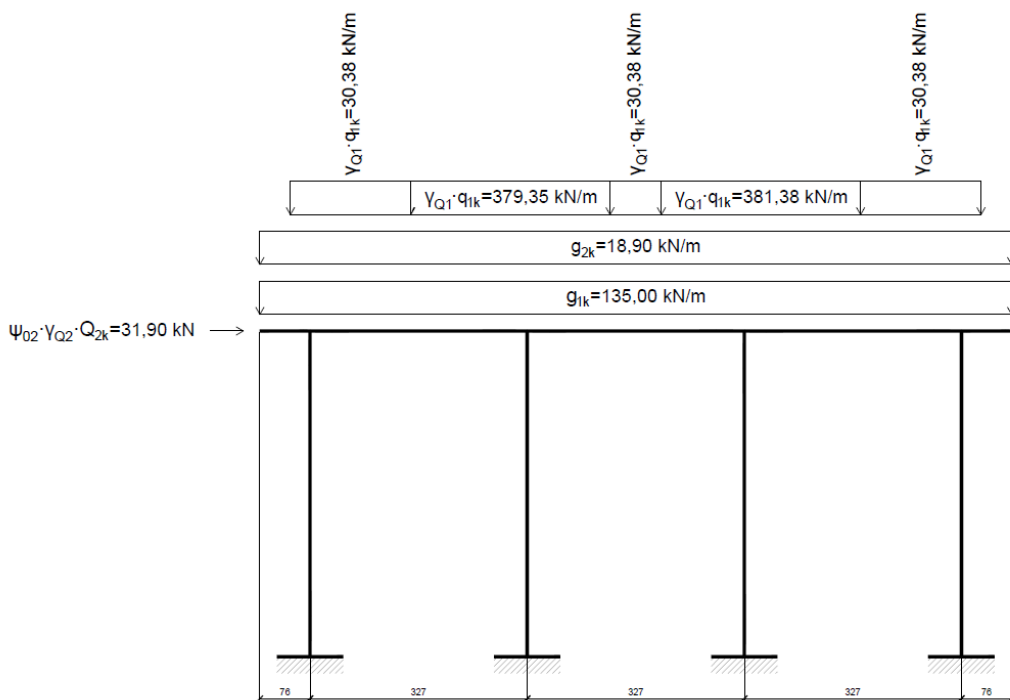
Schema statico della pila della US2 allo stato di progetto in combinazione SLU2.
